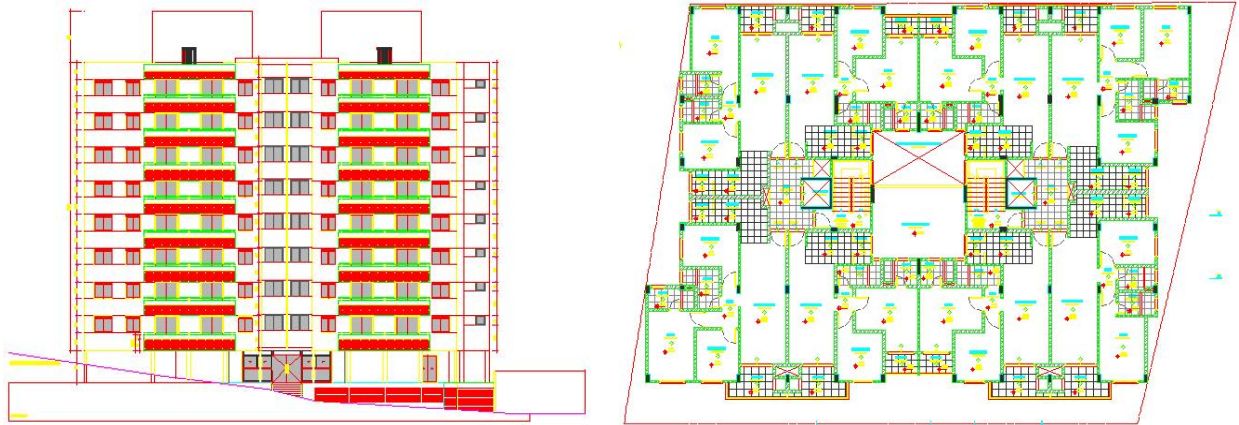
Projeto da fachada principal e do pavimento tipo do empreendimento A
